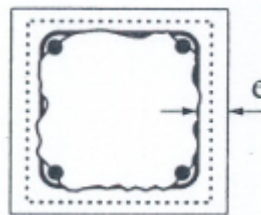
Disposição das armaduras mais utilizado no encamisamento de pilares. (Gomes, A., Appleton, J.).
